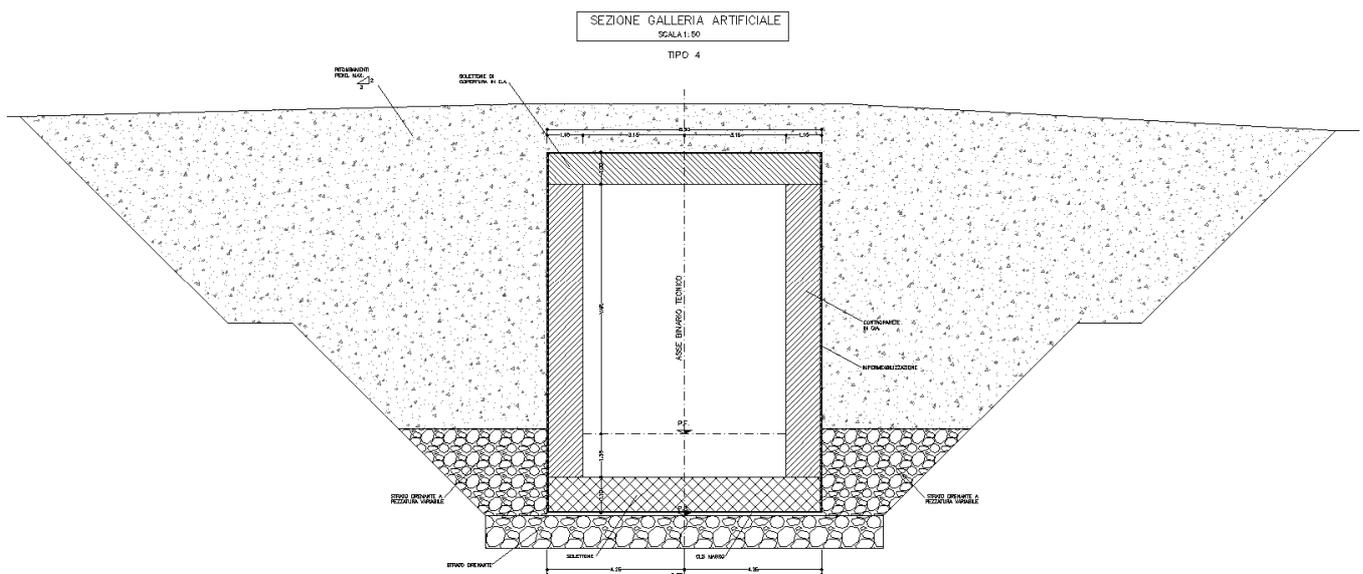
Sezione tipo Galleria artificiale "Drenante" (sezione tipo "4")
